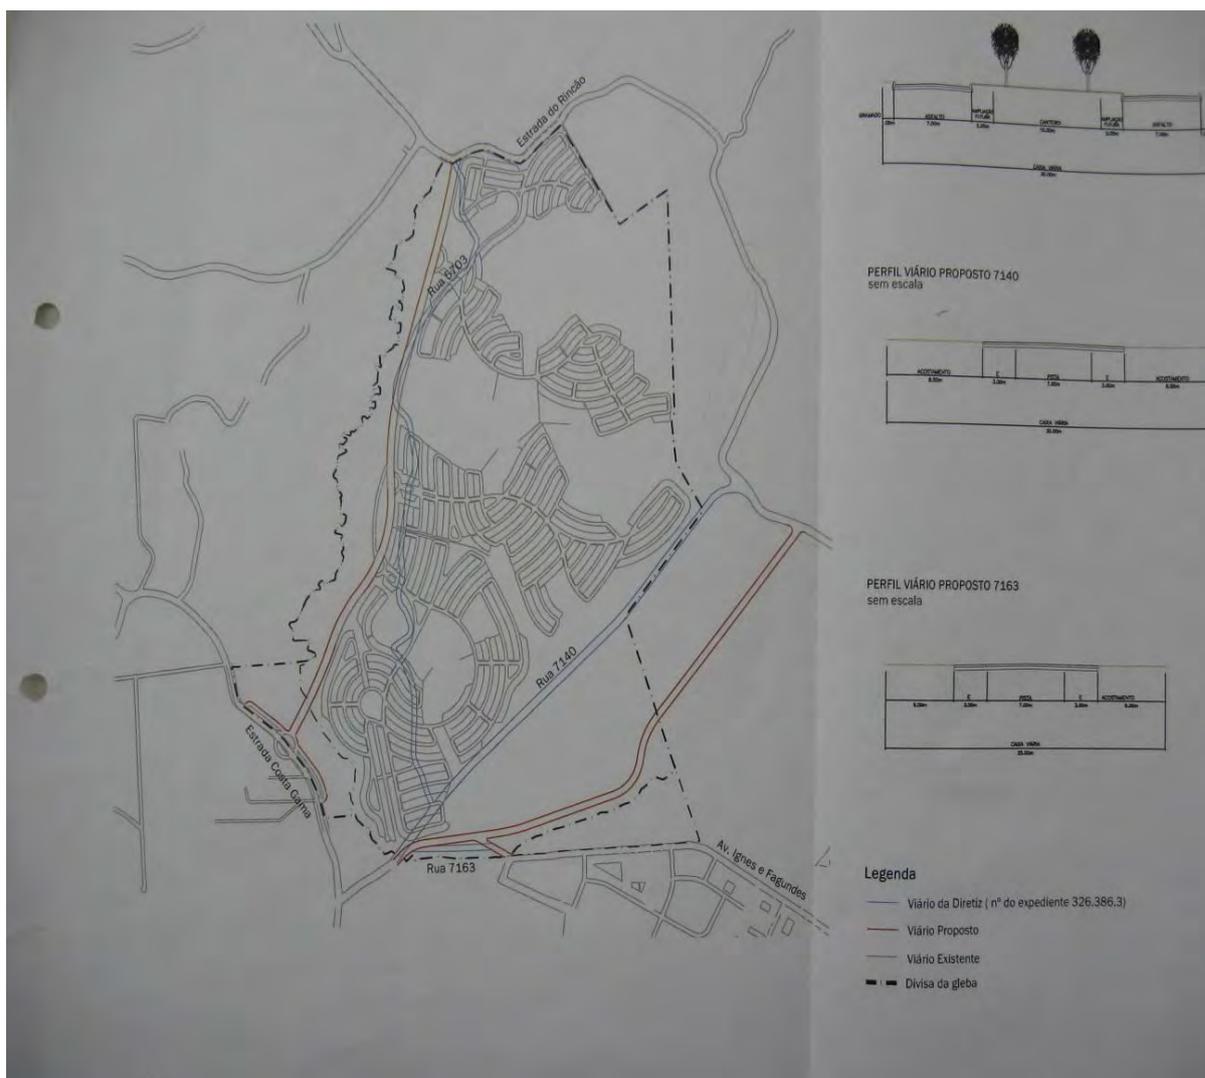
Projeto do condomínio, traçado viário existente e proposto. Fonte: SPM, 2011.
